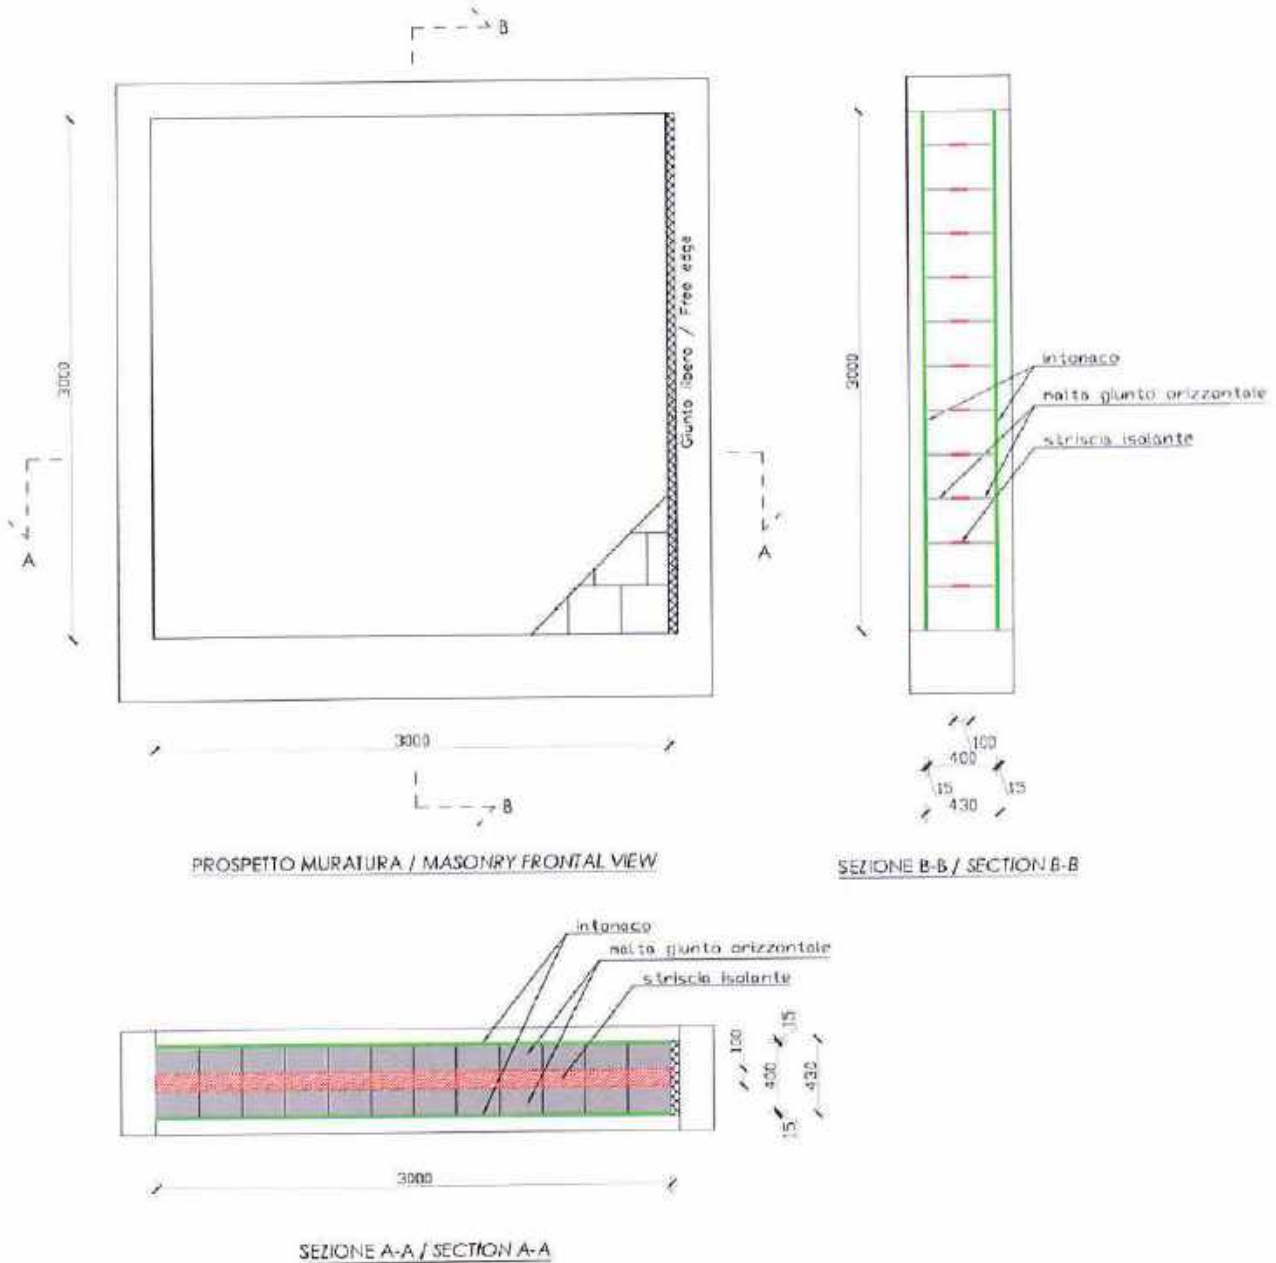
Prospetto e sezioni muratura / Masonry frontal view and sections
